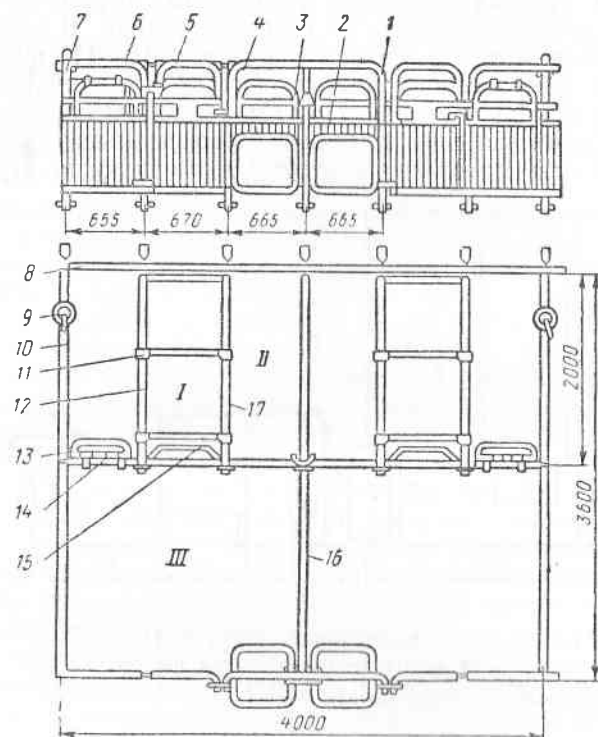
Общий вид и план станка ССИ-2 для фиксированного содержания свиноматок:
